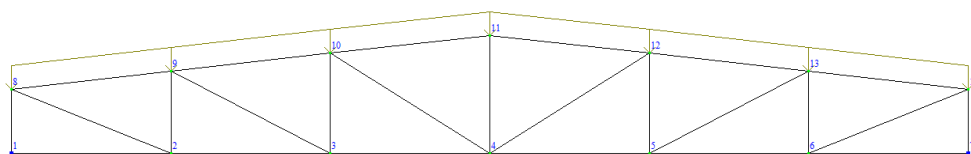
Расчетная схема с пронумерованными узлами
